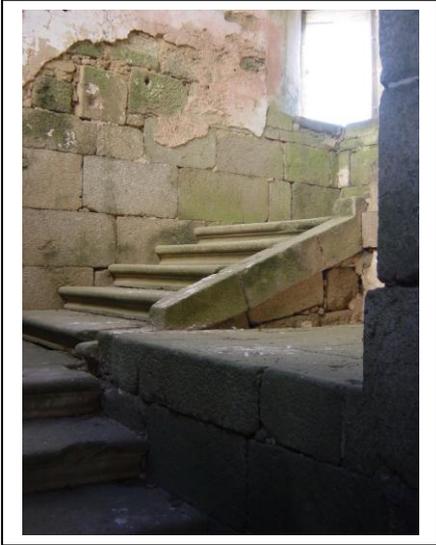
Escadas para o 1º piso. Foto da autora.
